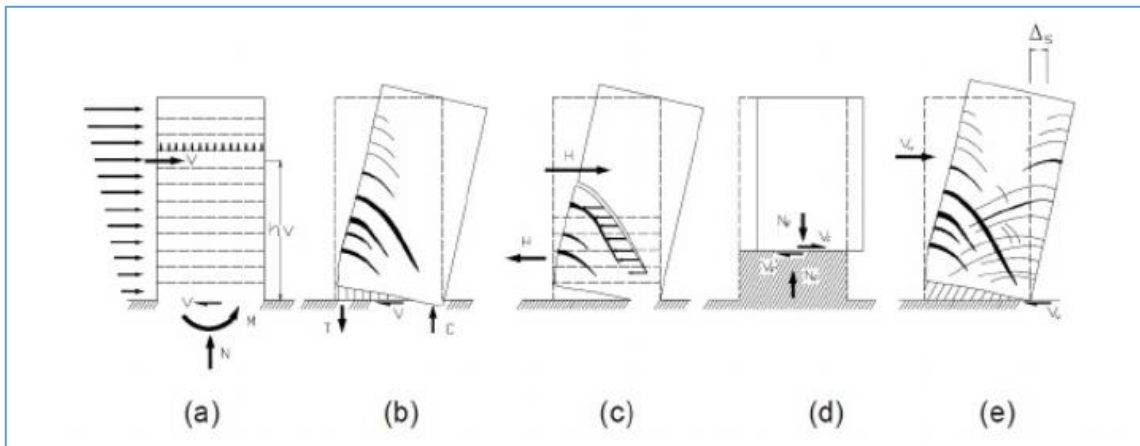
Fallas en muros estructurales portantes. Fuente: Bartolomé y Muñoz
